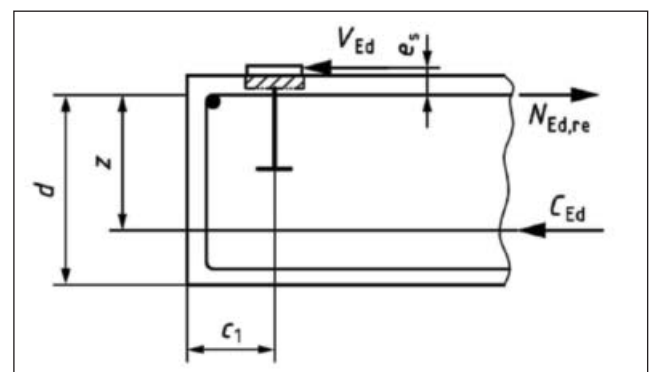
Befestigung mit Kopfbolzen am Bauteilrand mit Rückhängebewehrung, bestehend aus Bügeln und Randbewehrung (nach EN 1992-4 [2])
